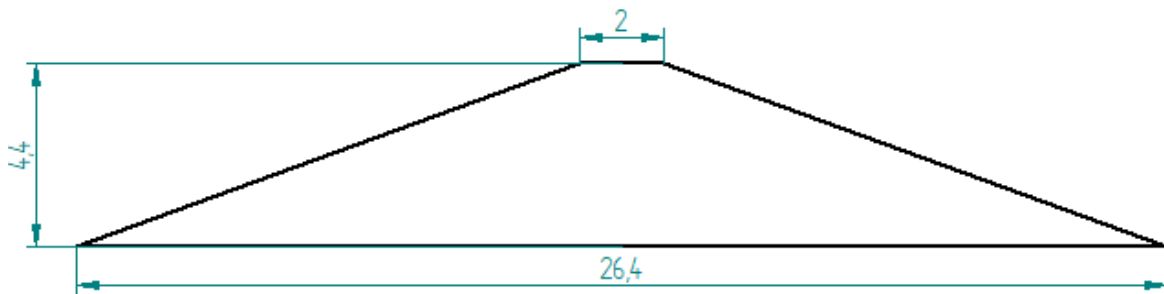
Sección de la estructura ISO (m). Fuente propia.
